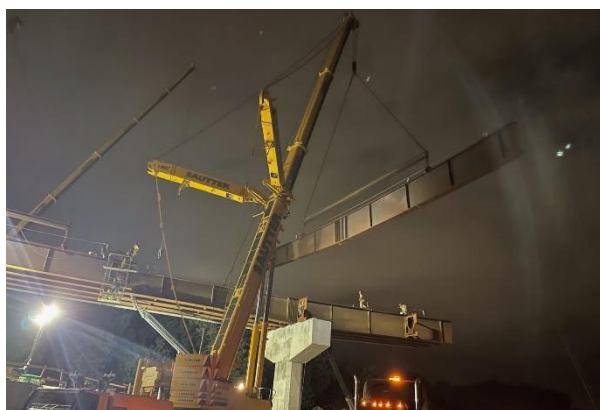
Vista general de la construcción de las estructuras de la I-66 en el cruce con la I-495
